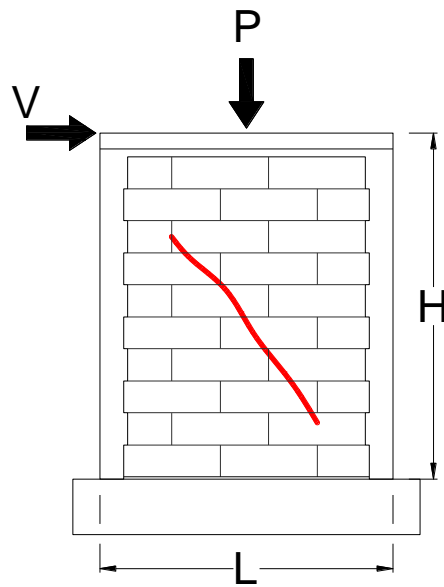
Grieta diagonal en un muro confinado.
